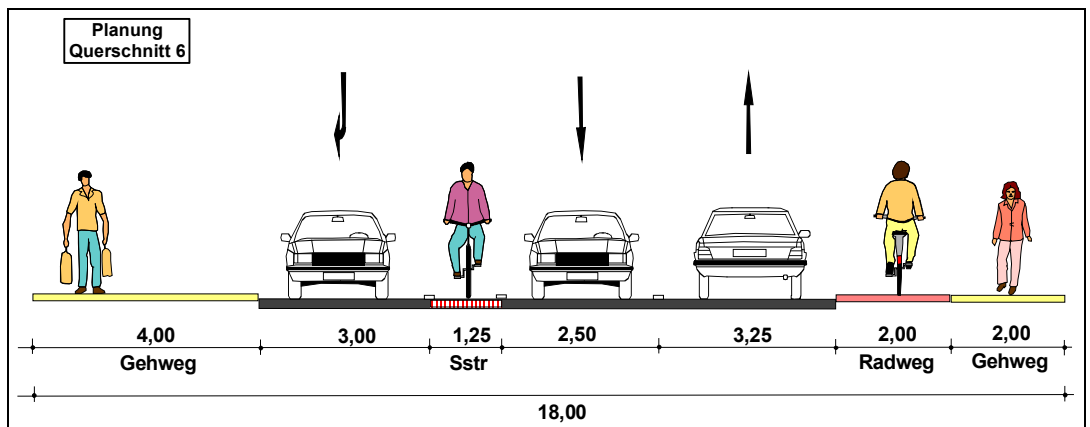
Elsässer Straße – Planung Abschnitt 6
